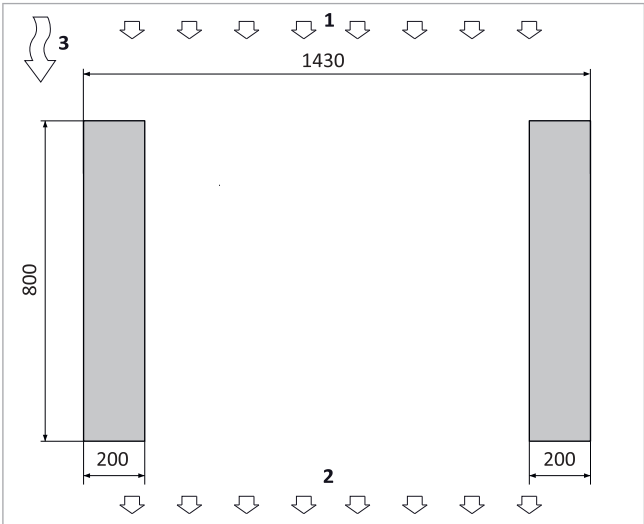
Fondamenta a strisce per SolvisMia (vista dall'alto)
